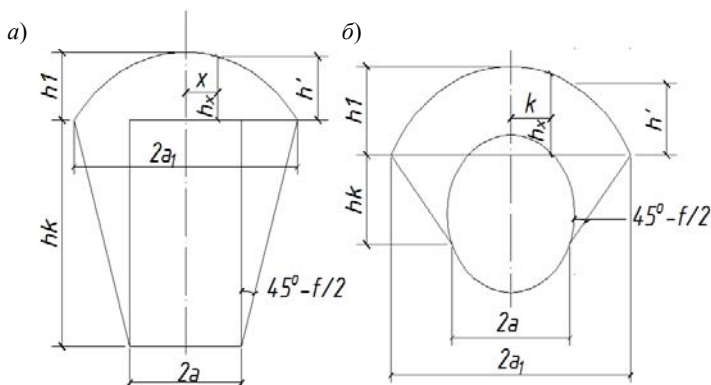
Расчетные схемы для определения вертикального горного давления по пролету сооружения прямоугольного (а) и круглого сечения (б)
